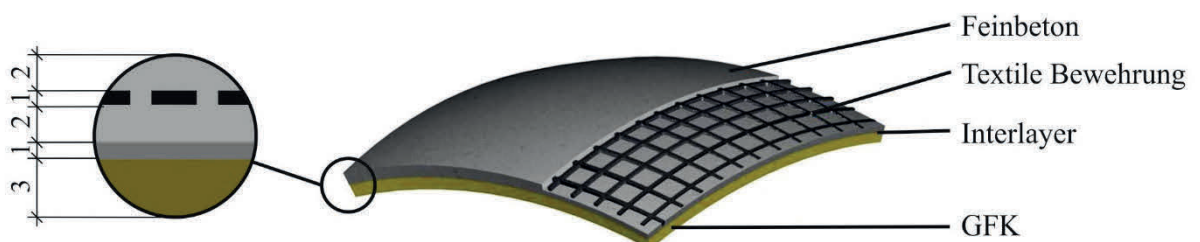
Schematischer Aufbau der Textilbeton-GFK-Hybridbauweise (BetoTexG, Angaben in mm)
